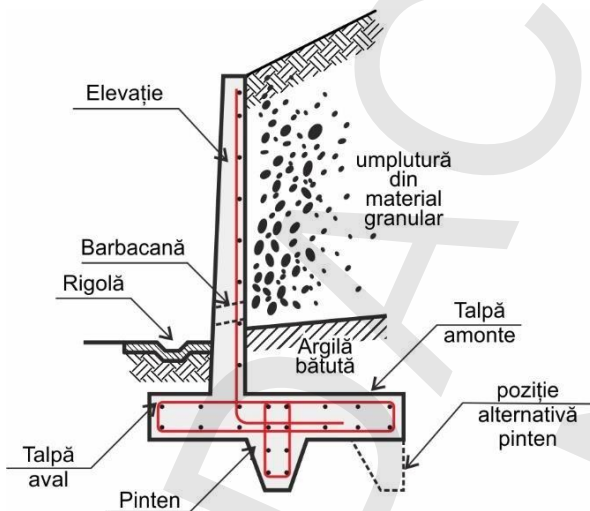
Elementele componente ale unui zid de sprijin din beton armat
